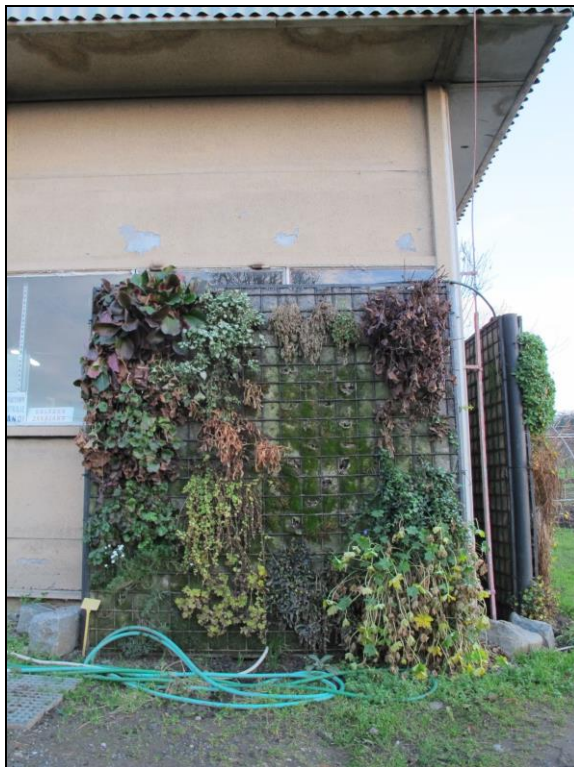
, 168: Stěna A, stěna B (15.12.2014, autor: Petra Suldovská)
